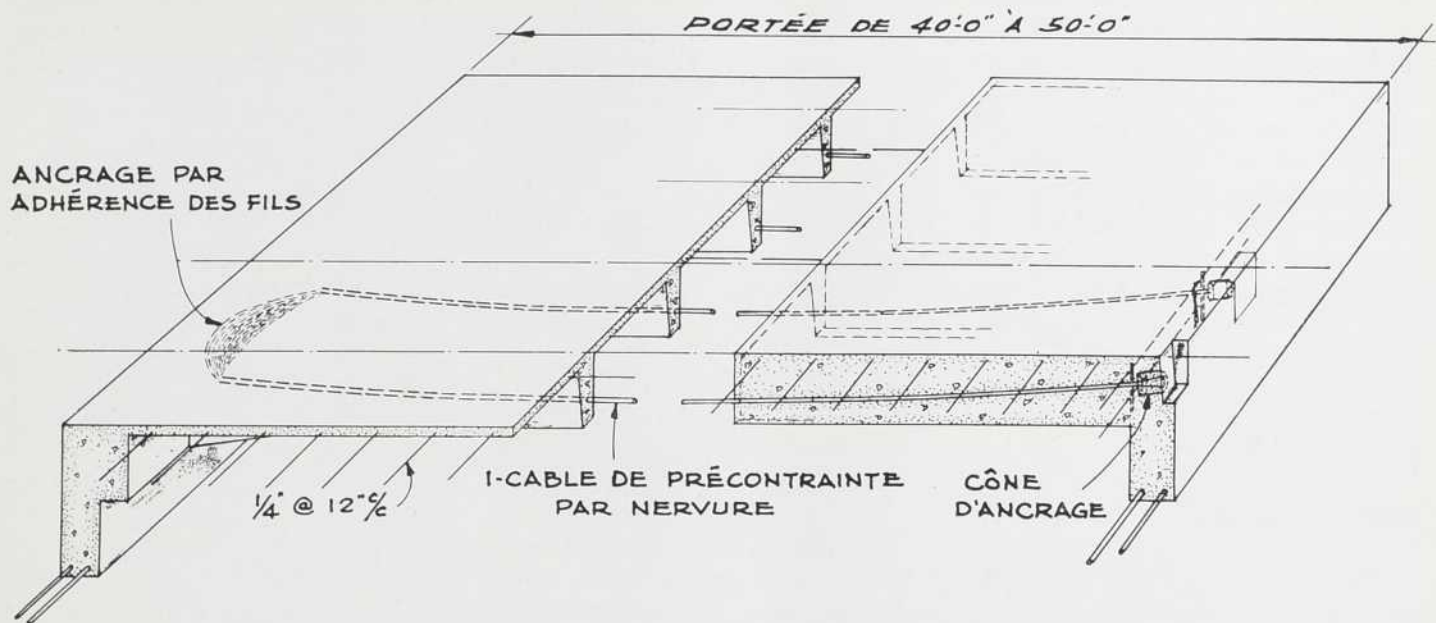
COUPE EN PERSPECTIVE D'UN PLANCHER TYPE
